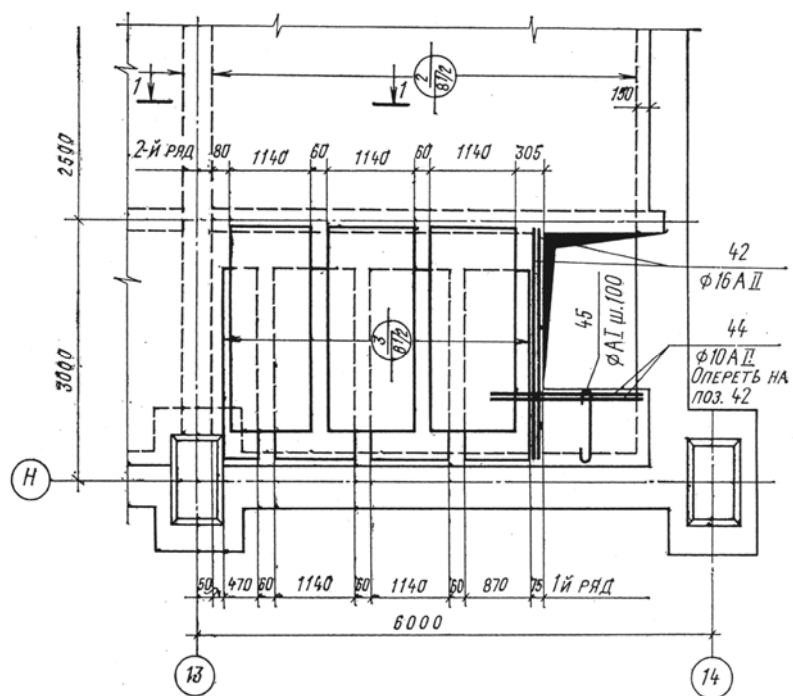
Раскладка нижних арматурных сеток Пм1
